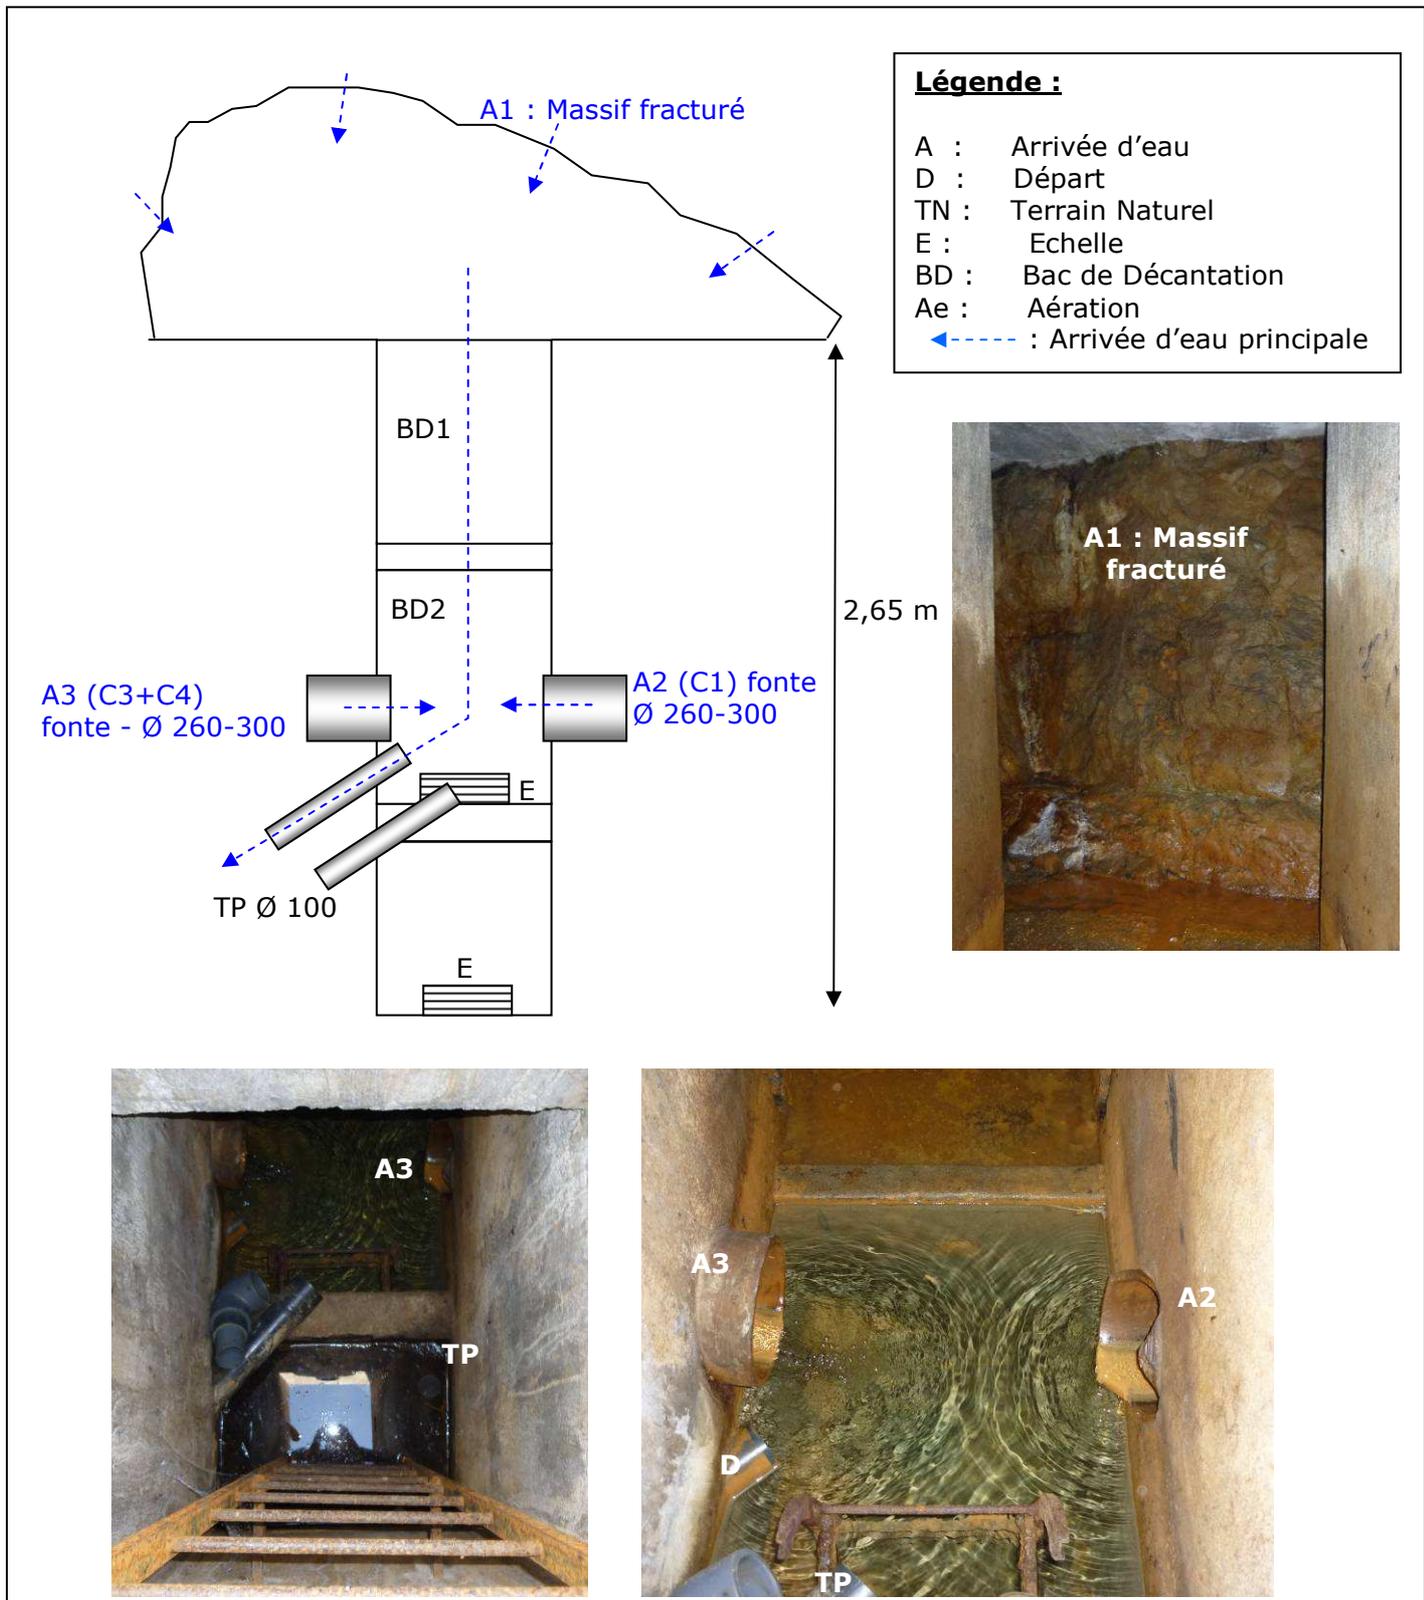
Vue en plan de l'ouvrage de Lempret C2
